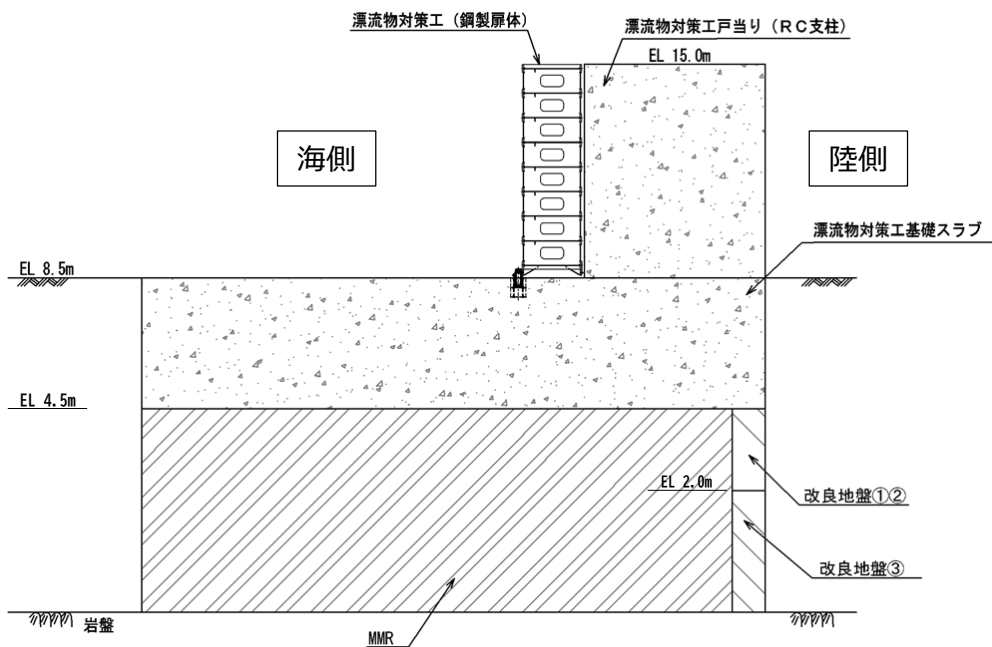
(2) 漂流物対策工の構造図 (基礎断面図, C-C 断面)
